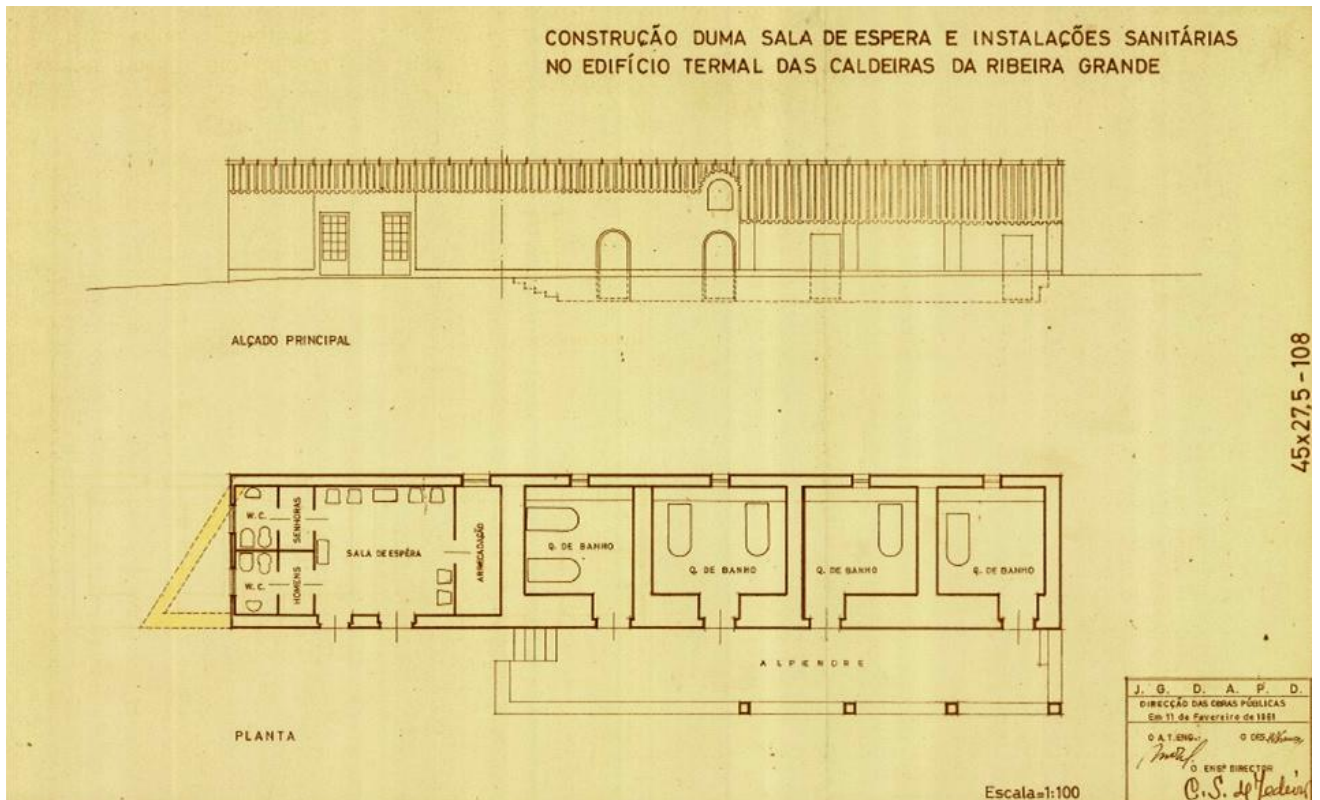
Planta e alçado do 1º projeto apresentado no processo de obras de 1961 para a construção de uma sala de espera e de instalações sanitárias
